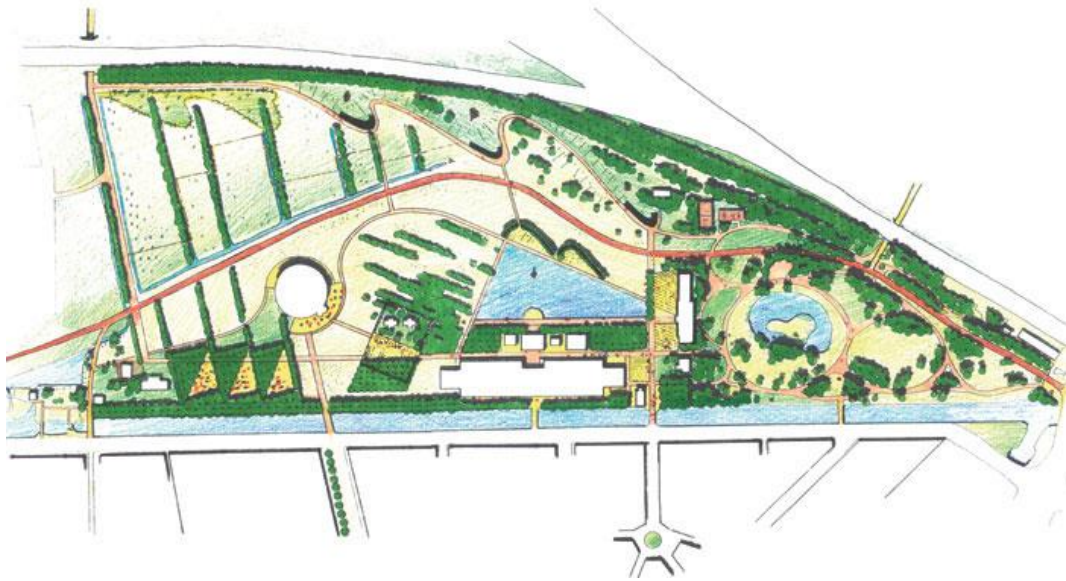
Apresentação de planta baixa geral do Westerpark.
